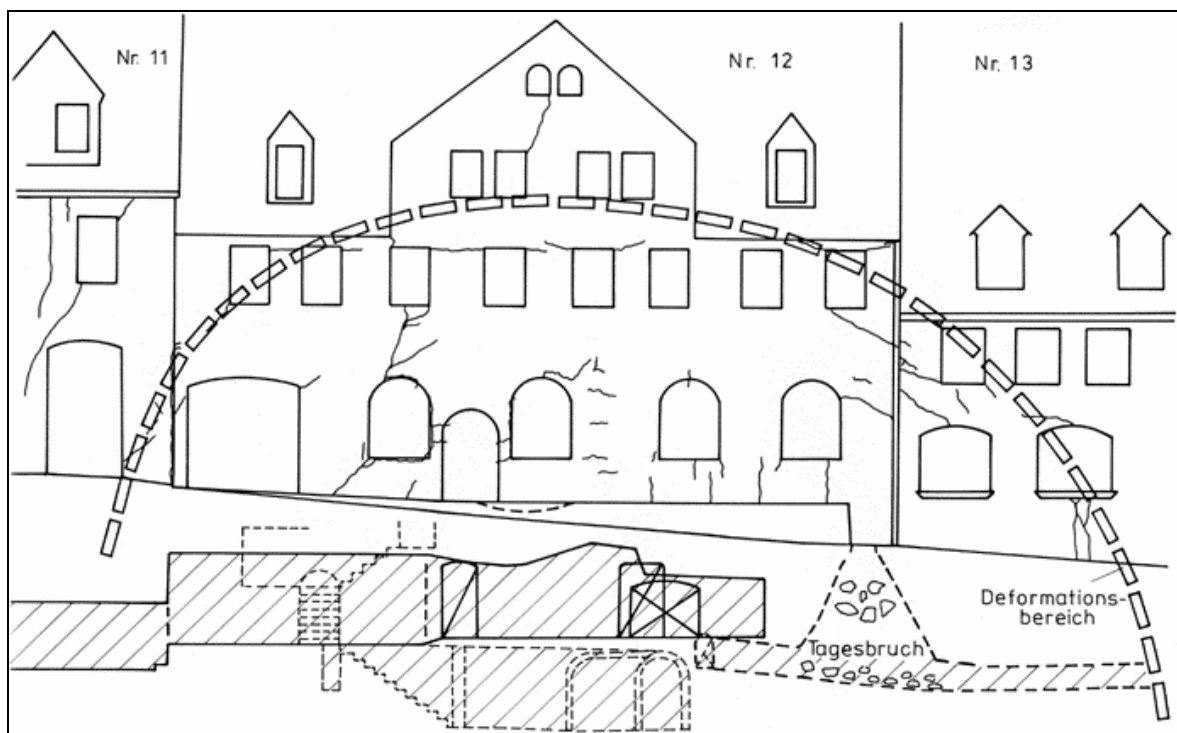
Schadensbild an der Fassade mit Rissstrukturen und Deformationszone (vereinfachter Ausschnitt)
